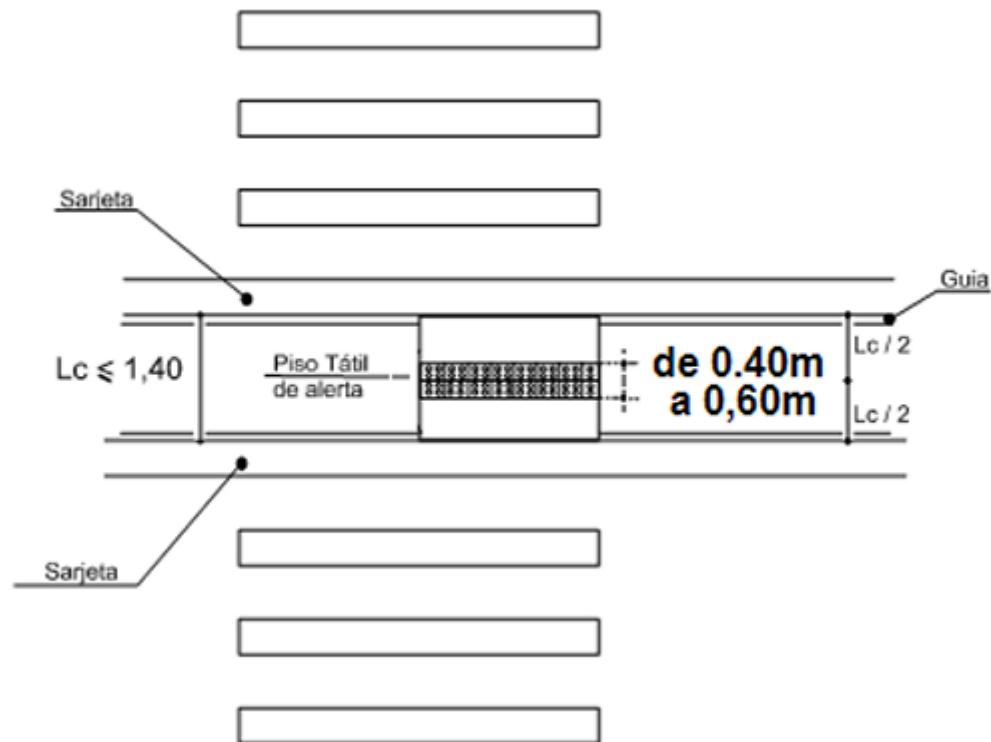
Planta - Rebaixamento em canteiro central inferior a 1,40m.
